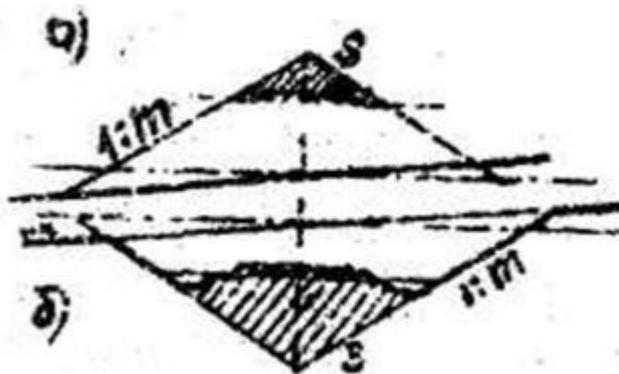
Схема к определению площади поперечного сечения и объема земляного полотна на косогоре: а) поперечное сечение насыпи; б) поперечное сечение выемки.
